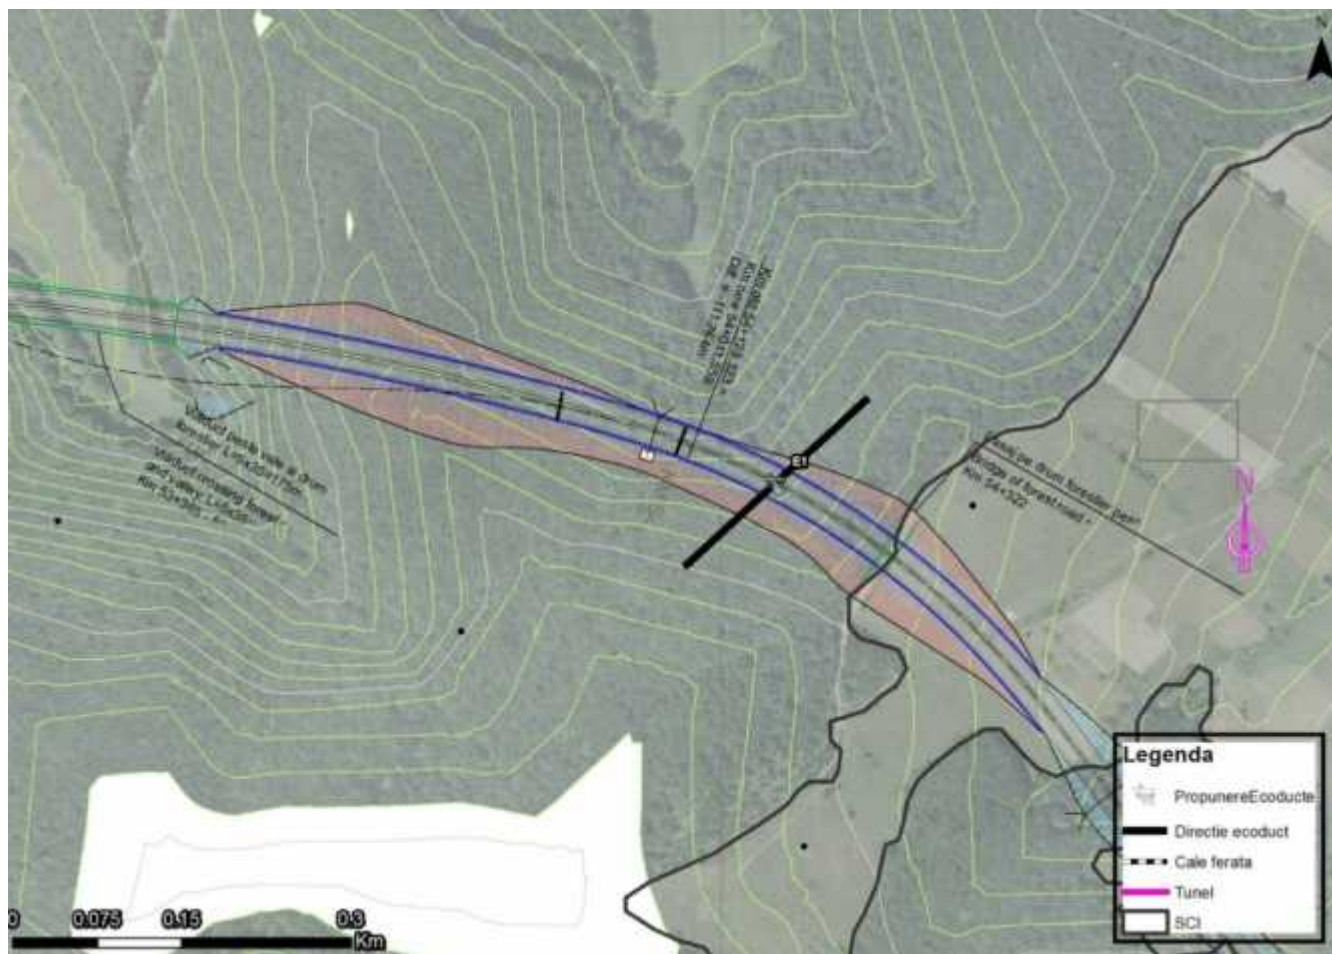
Propunere Ecoduct 1, detaliu plan autostrada
